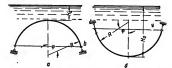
Внутрениие усилия в замкнутой шаровой оболочке от гидростатического давления: а — опертая оболочка, 6 — подвесная оболочка.
